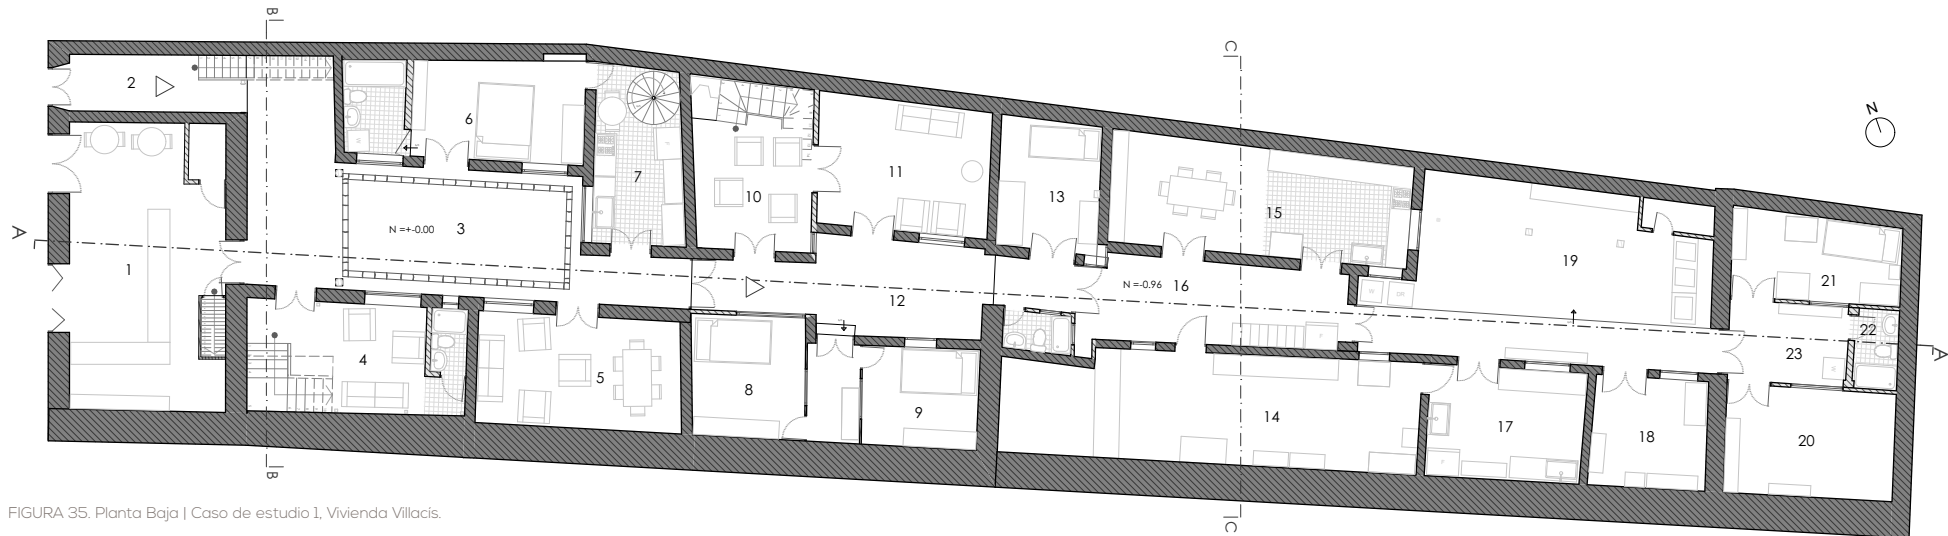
Planta Baja | Caso de estudio 1, Vivienda Villacís.
